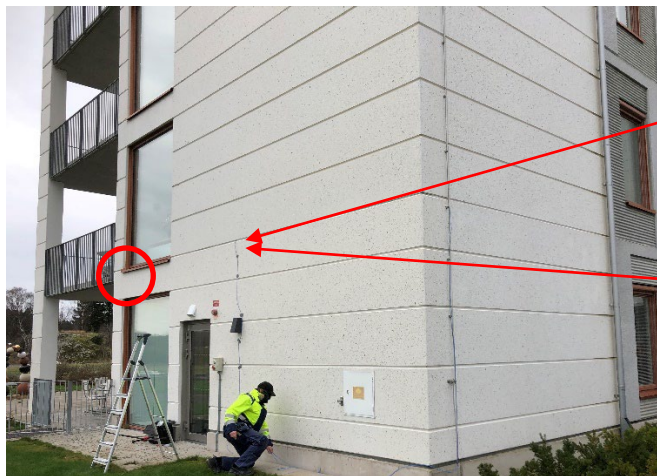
Mätpunkternas placering, plan 7 (objekt 1A).
